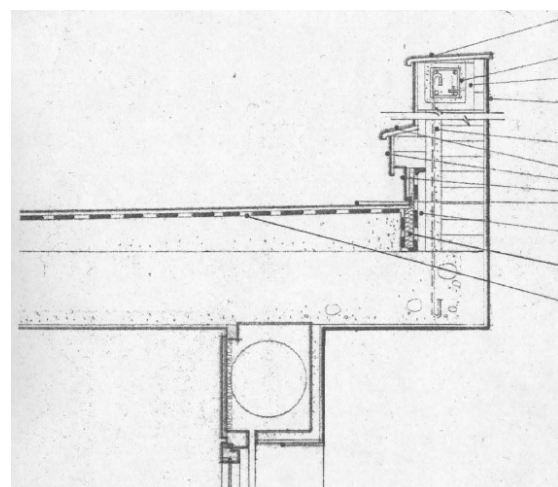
Secció transversal de coberta, El Prat I d' El Prat de Llobregat. Coberta plana amb rajola manual, amb junt perimetral i sense aïllament.
